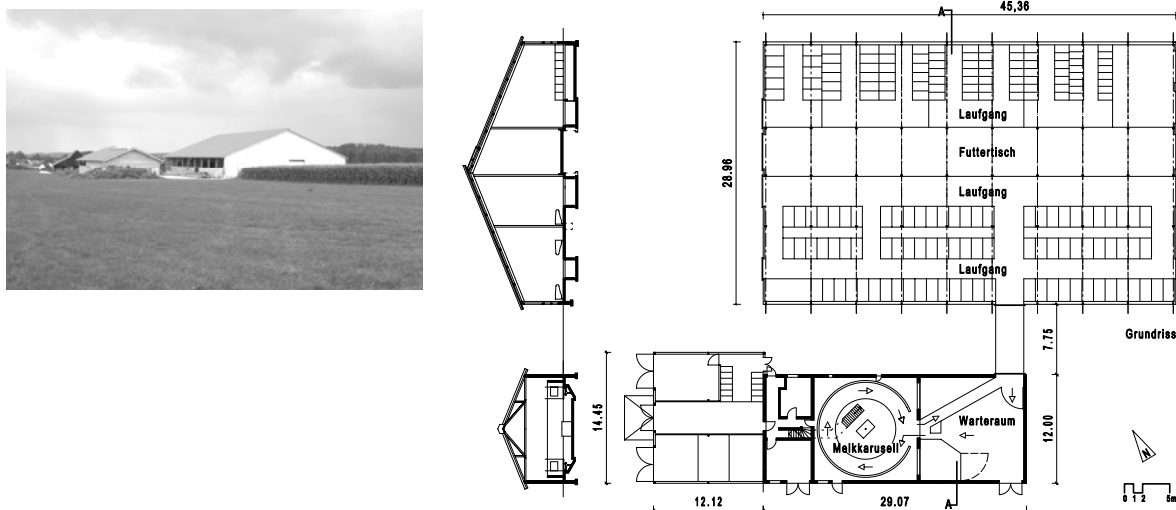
Ansicht, Grundriss – Schnitt
